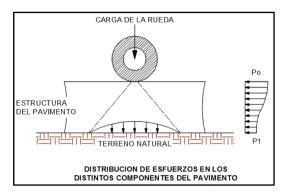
Distribución e incremento de los esfuerzos de un pavimento flexible.
